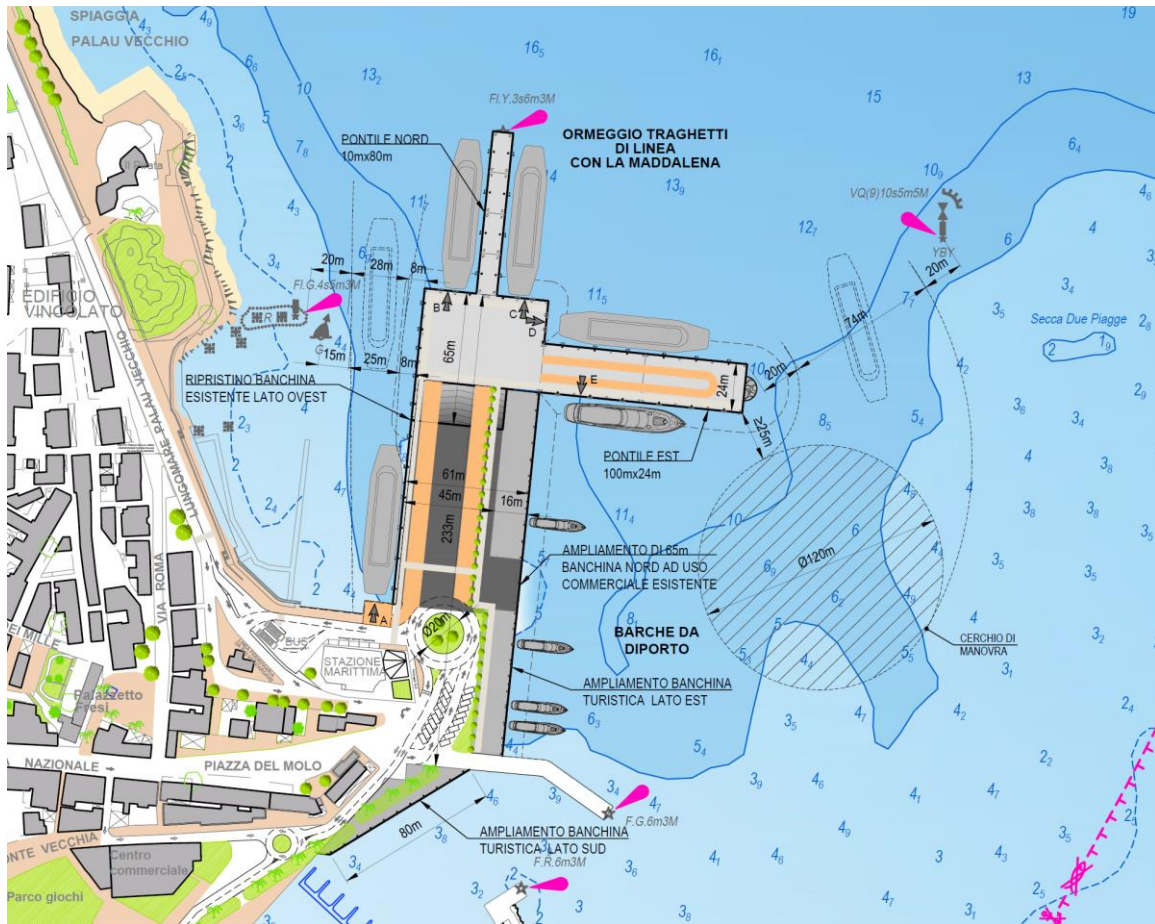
Ipotesi di "Assetto finale": Planimetria generale
